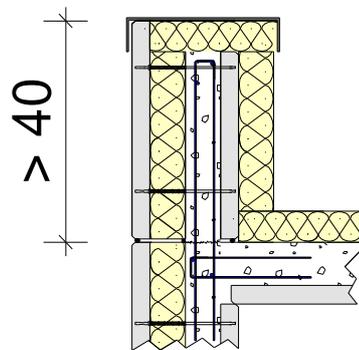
Acrotère haut constitué d'un Thermacoffrés® rapporté
